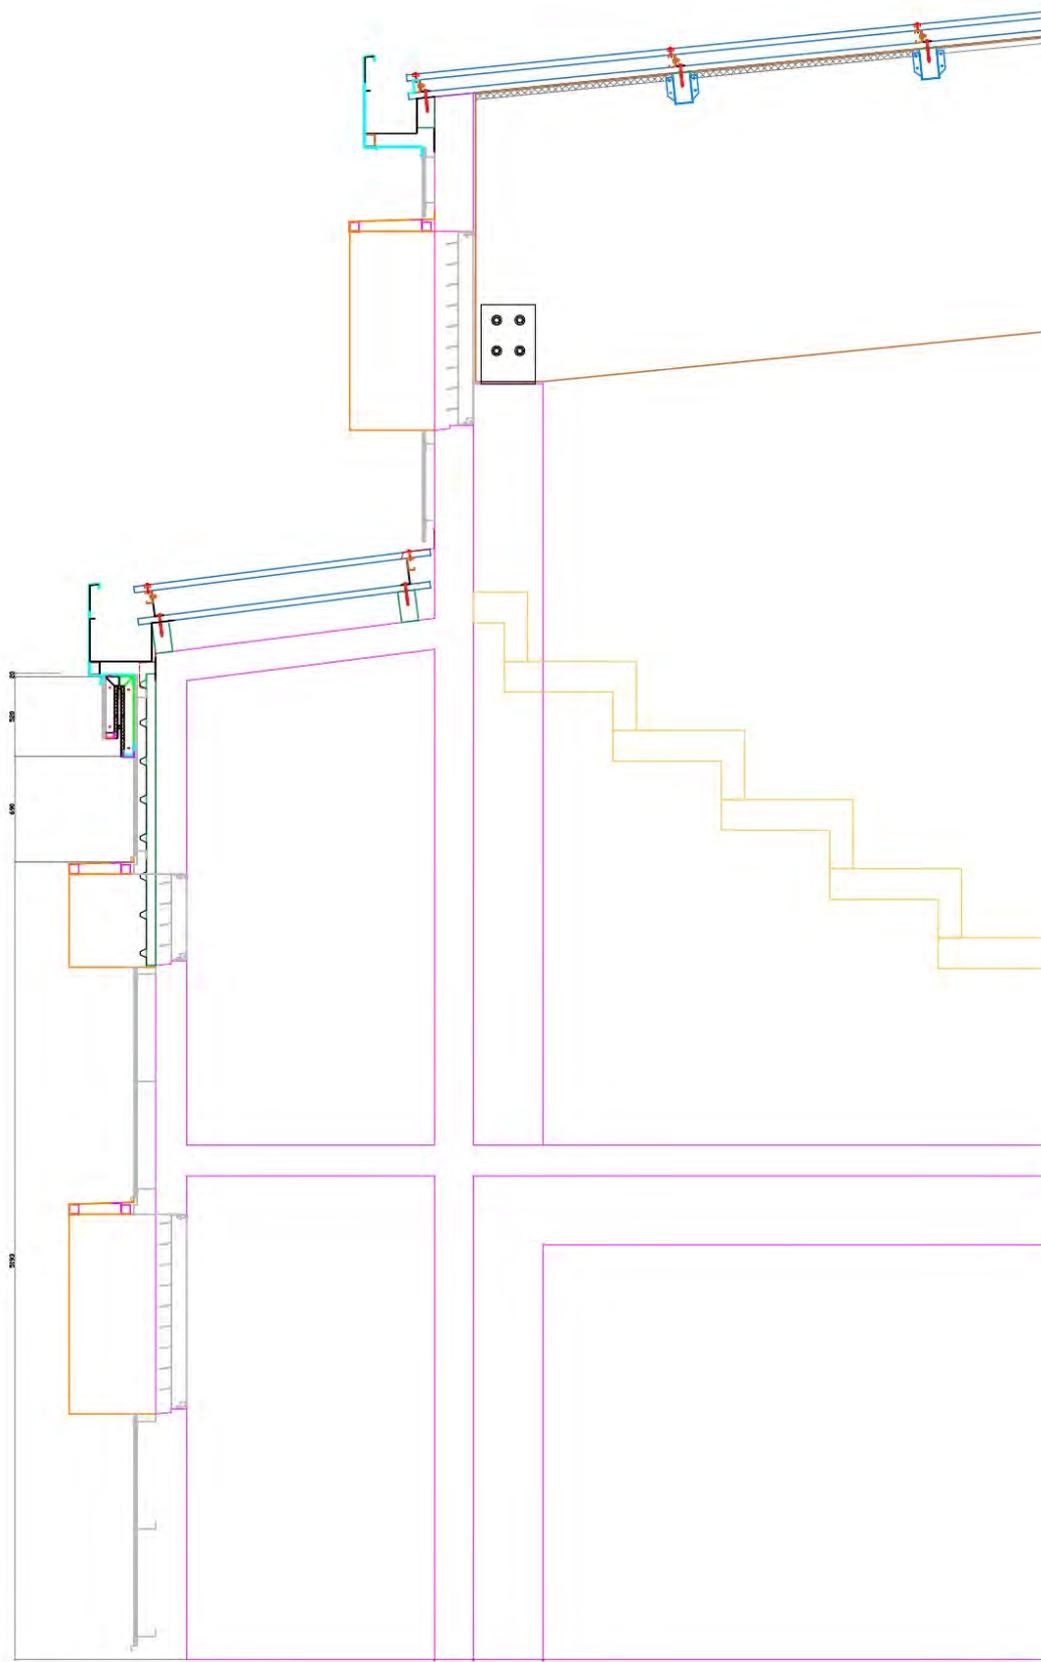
coupe en façade sud - gîtes au-dessus des casquettes
